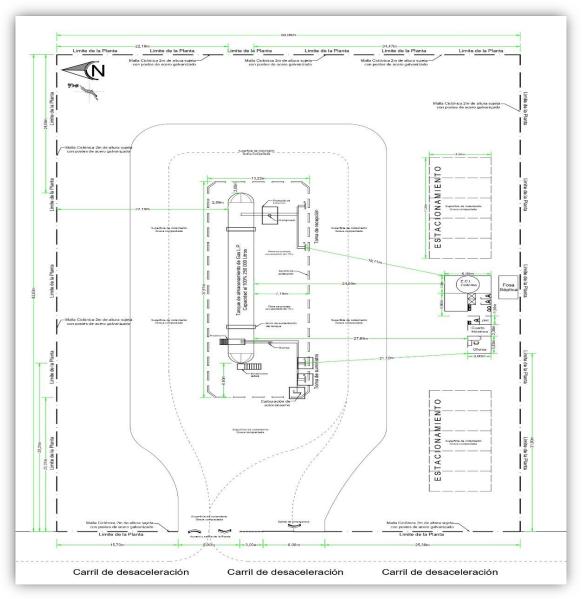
Plano General de la Planta de Distribución de Gas L.P.
